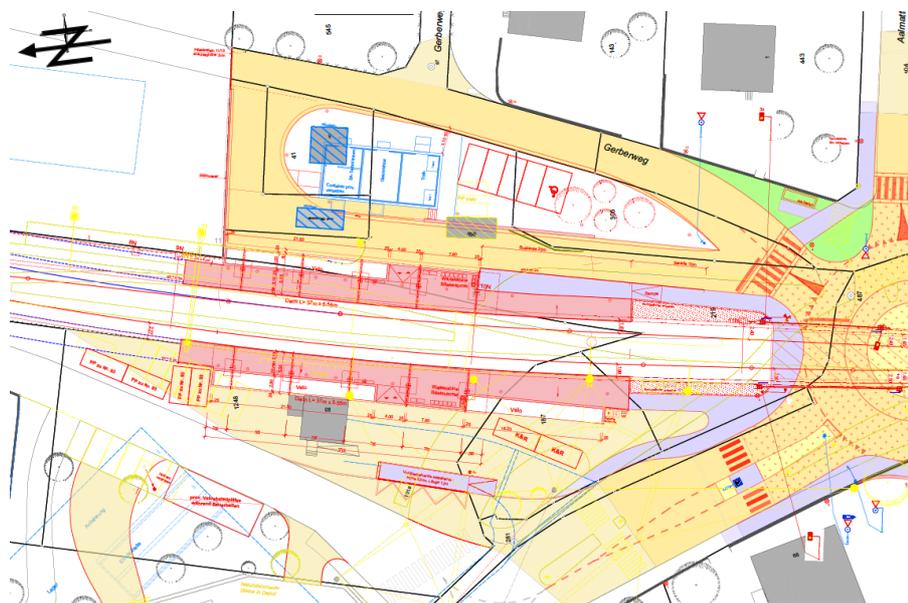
Situationsplan «Publikumsanlage» Bahnhof Nidau; Auflageprojekt (Stand: 06.10.20)
